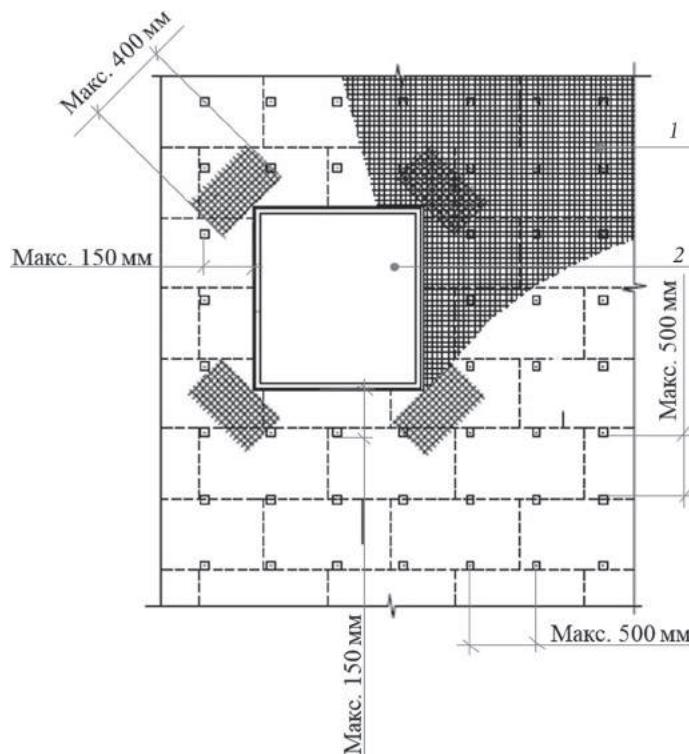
Схема установки теплоизоляционных плит, крепежных элементов и армирующей сетки: 1 — штукатурная сетка по всей поверхности минераловатных плит; 2 — угол здания
